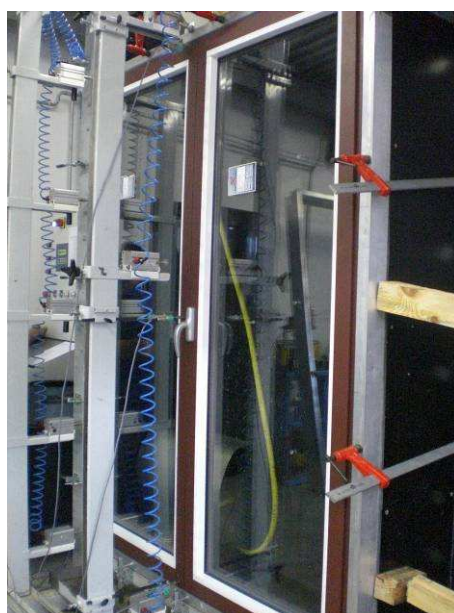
Detalle de perfiles, drenajes y juntas.
